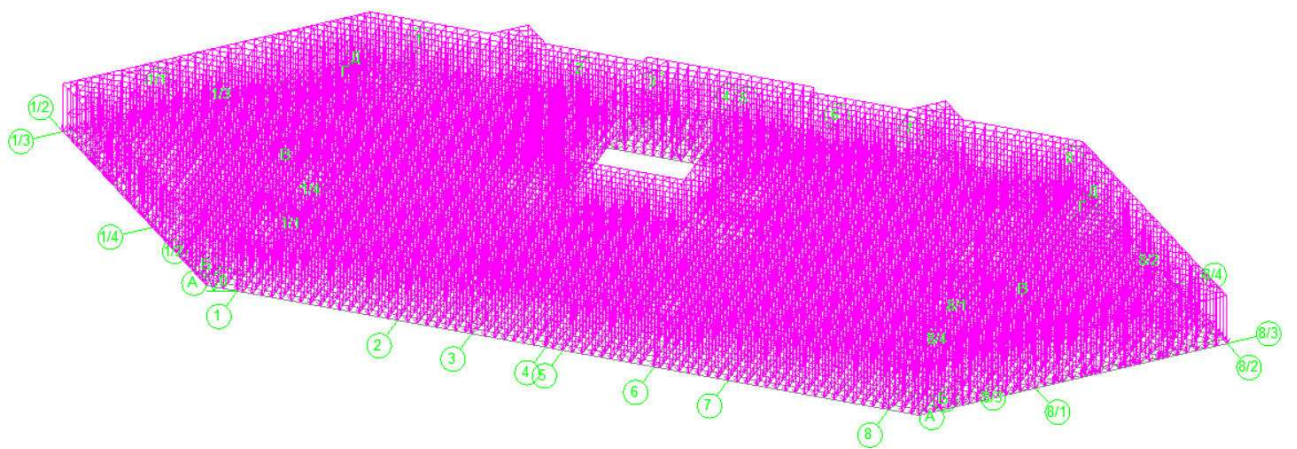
Загрузка плиты перекрытия собственным весом
